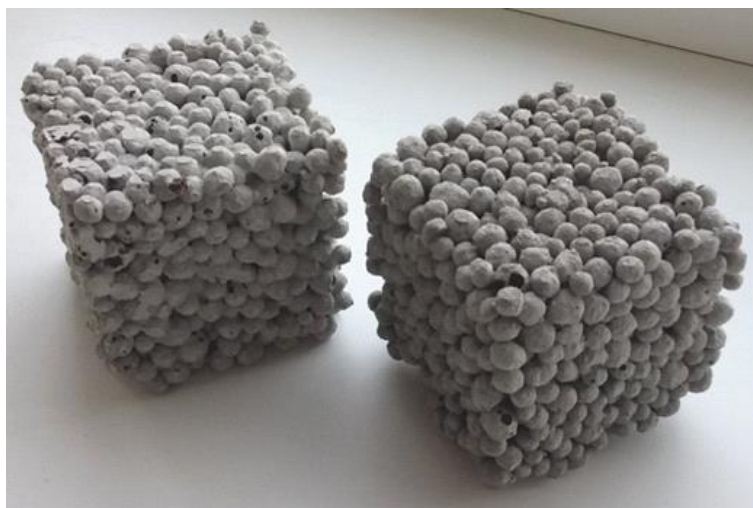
Лабораторный образец блока «Термокомфорт»
